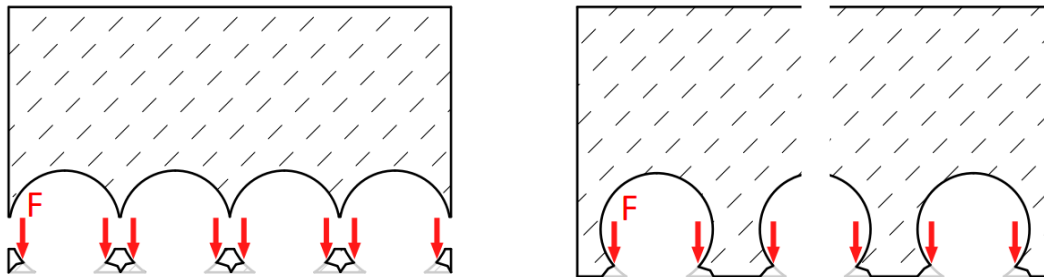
Längsschnitt (li) und Diagonalschnitt (re) des Versagens unter Zuglast durch den Verbindungspartner Einhängekomponente und Betonbruch in Form eines Betonausbruchkegels
